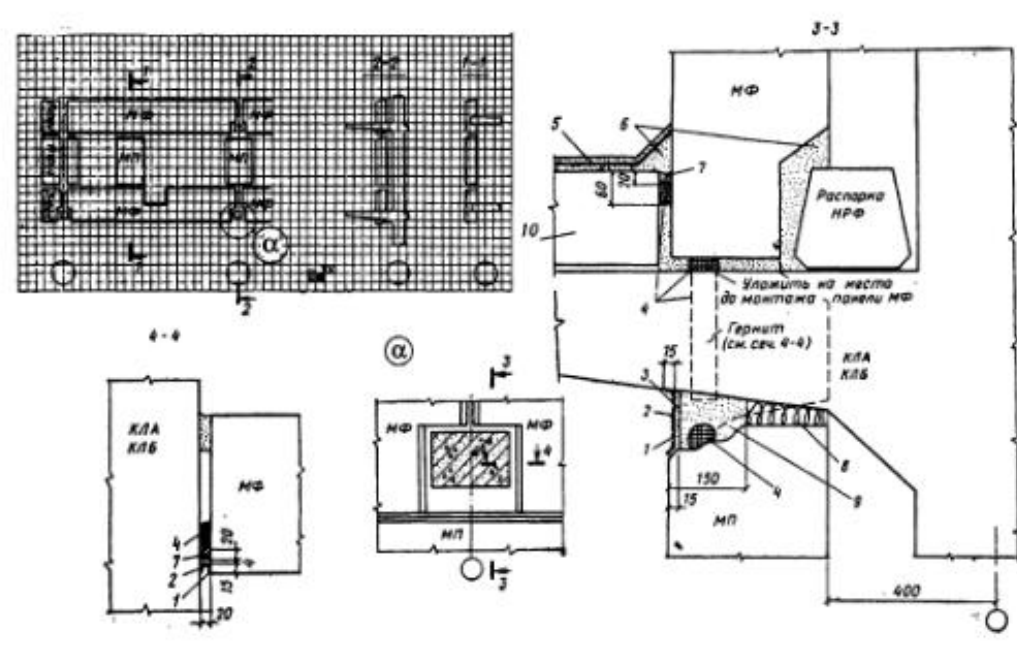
Фрагмент монтажной схемы фасада каркасного здания с выпусками консолей колонн: МФ - фасадная стеновая панель; МП - простеночная стеновая панель; МФУ - фасадная угловая панель; НРФ - настил-распорка фасадный; КЛА, КЛБ - колонны лоджий; 1 - окраска; 2 - герметизирующая лента; 3 - затирка цементным раствором; 4 - гернит; 5 - два слоя рубероида на битумной мастике; 6 - цементно-песчаный раствор; 7 - герметизирующая мастика; 8 - смоляная пакля; 9 - керамзитобетон; 10 - плита балкона (лоджки)
